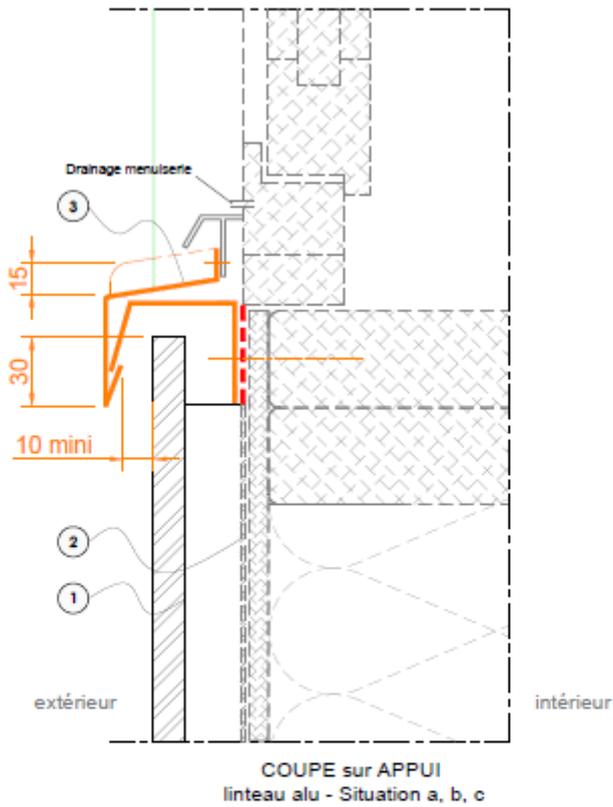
Menuiserie en tunnel au nu extérieur – Coupe sur linteau de baie
